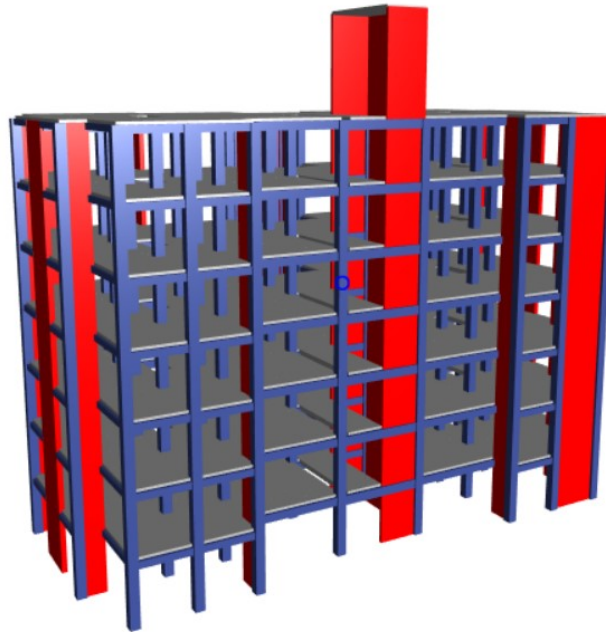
Modelamiento Superestructura Sistema Dual – Edificio Blesser. Vista 3D. Fuente: Elaboración Propia.
